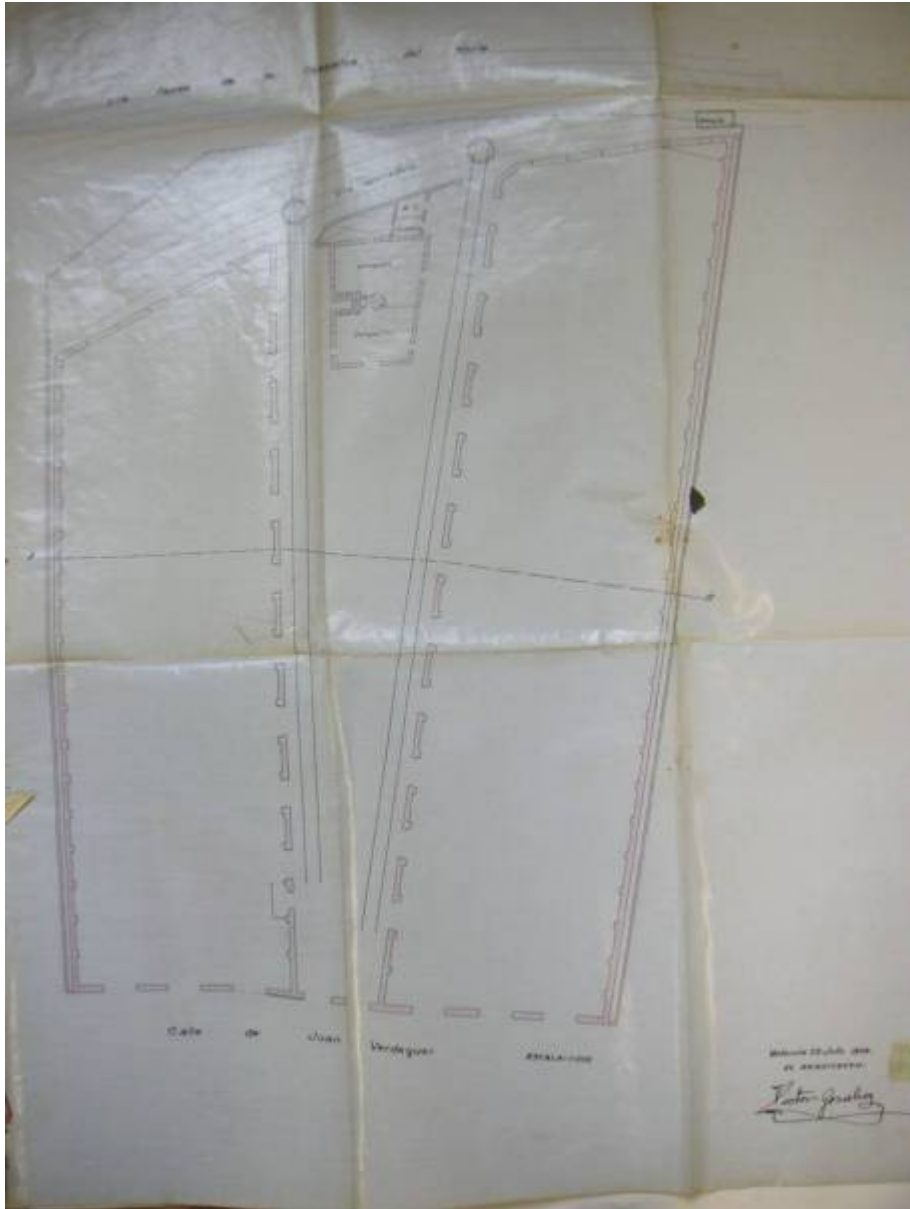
Planta proyecto original de naves.<sup>500</sup>
